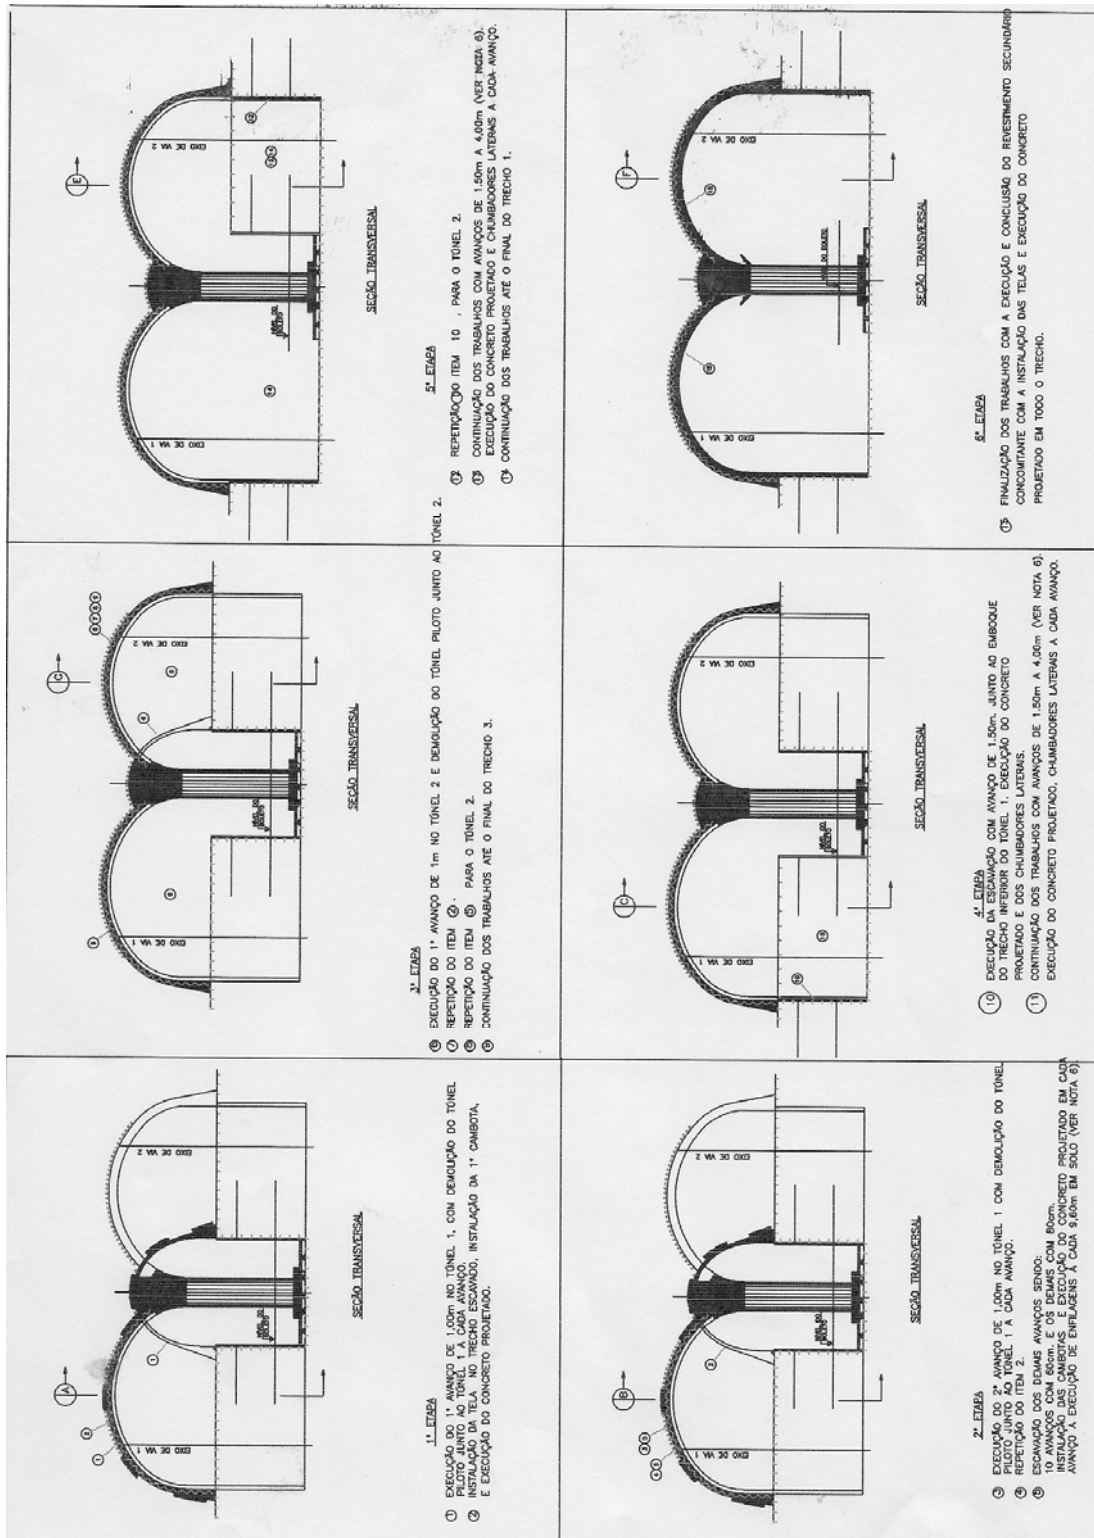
Processo construtivo do trecho do emboque (modificado – Metrosal 2001j)
